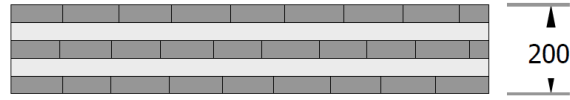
Planchers CLT – 200 mm – 5 plis
